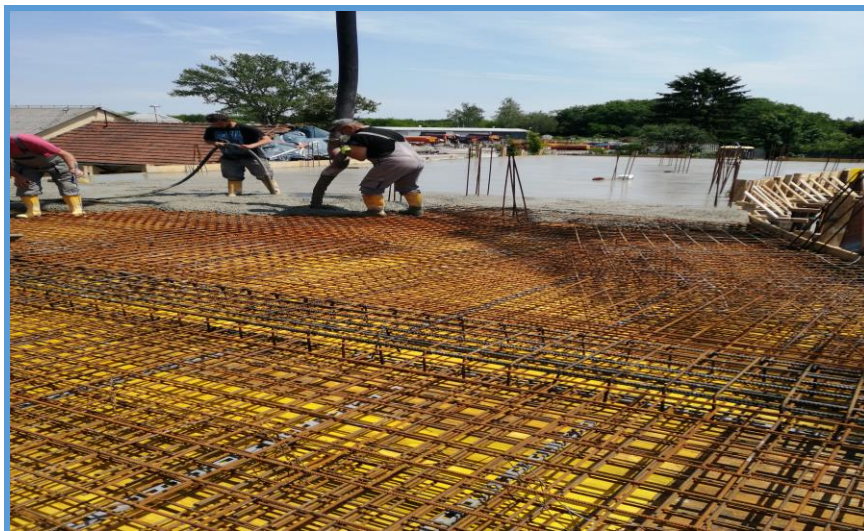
Betoniranje podne ploče prizemlja – zgrada 1 [8]
